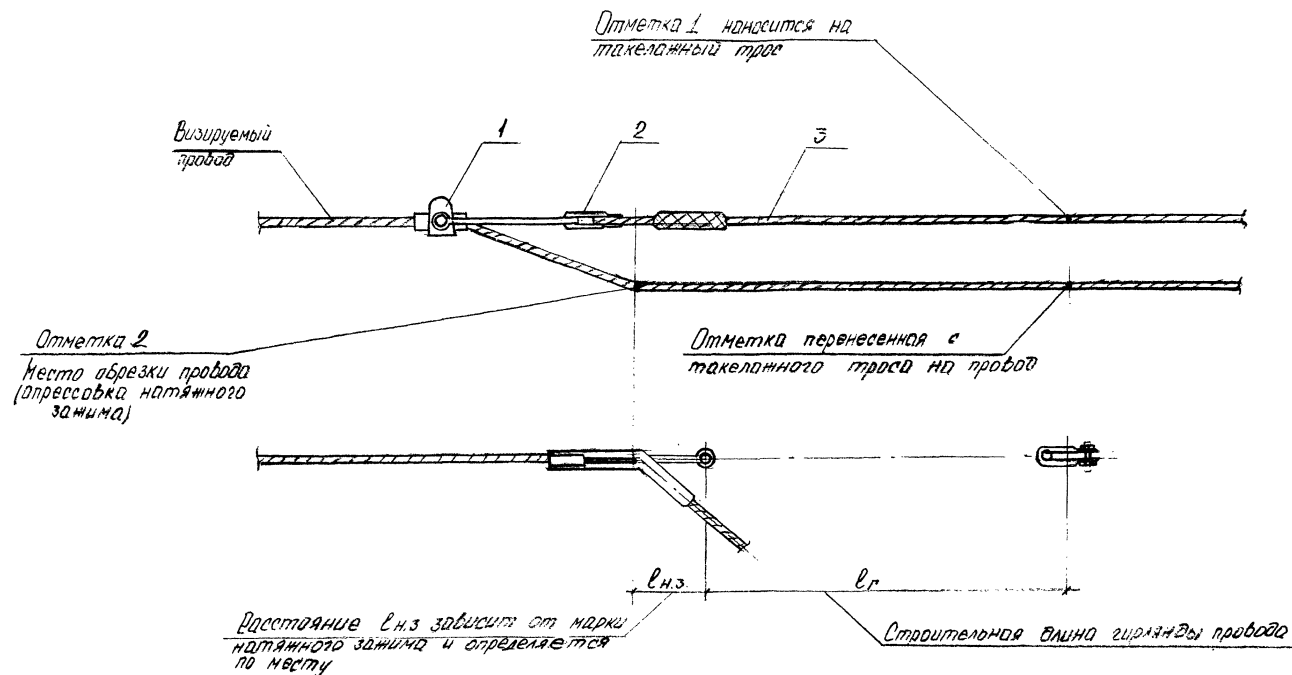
Схема переноса отметок с такелажного троса на провод
